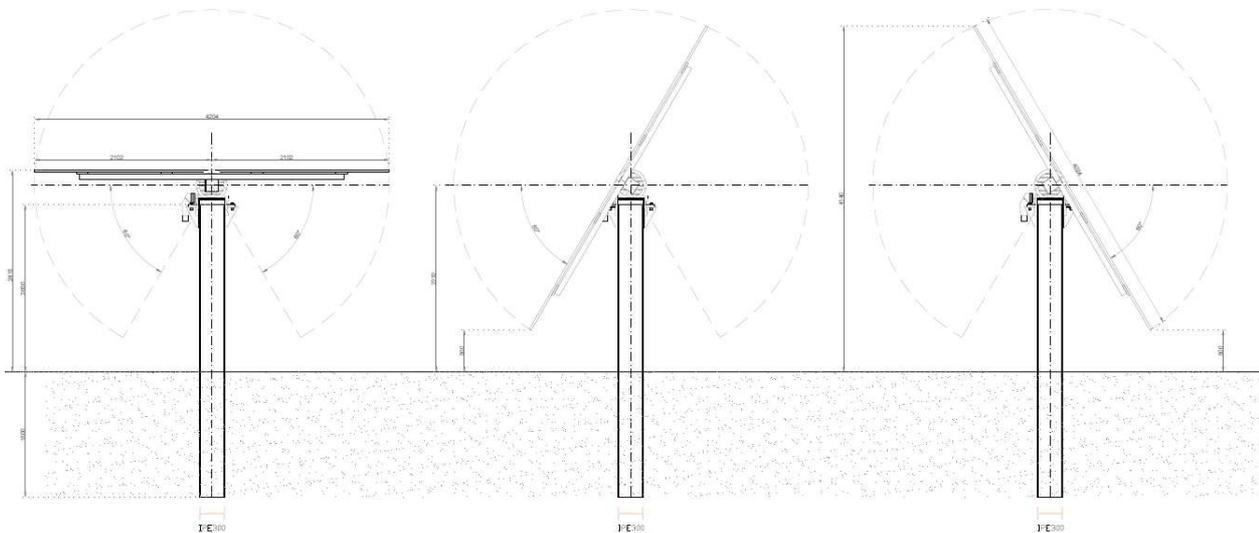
Layout dell'inseguitore SOLTEC, con pannelli montati perpendicolarmente all'asse di rotazione.
